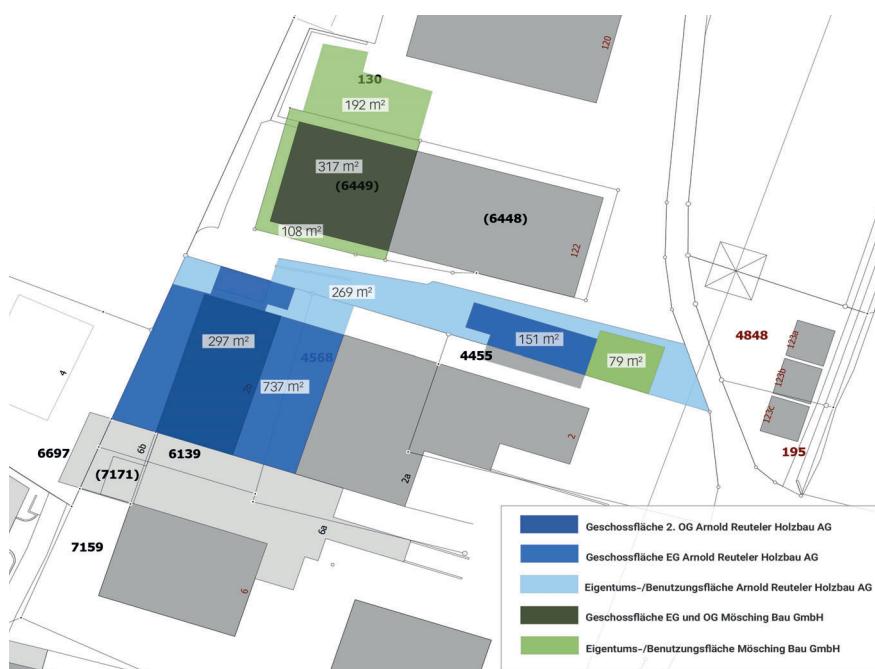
Flächennutzungsplan der Arnold Reuteler Holzbau AG und der Mösching Bau GmbH
